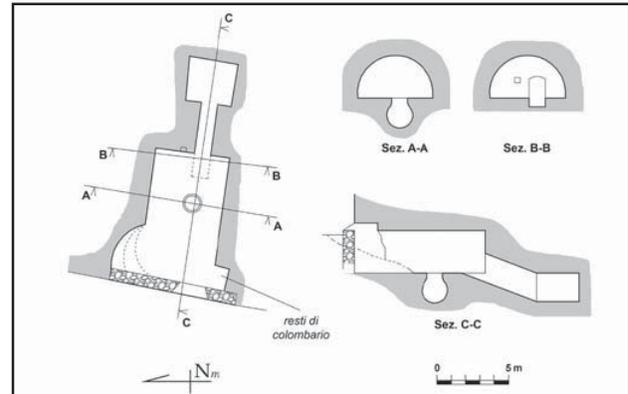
Planimetria e sezione dell'ipogeo n. 43 (Copyright CRSE).
